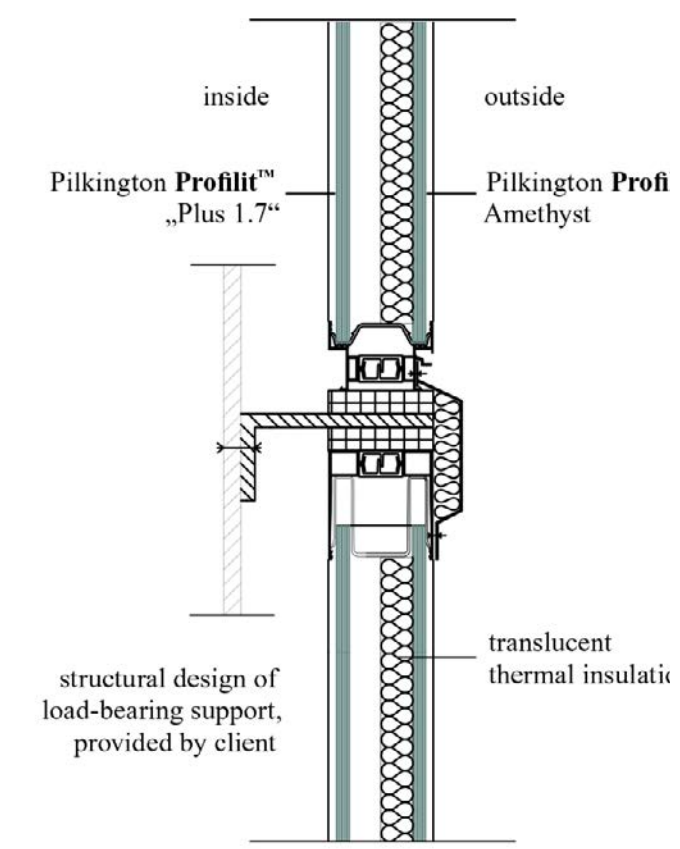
RÁMŮ PROFILOVANÉHO SKLA NAD SEBOU (US) „PILKINGTON“
